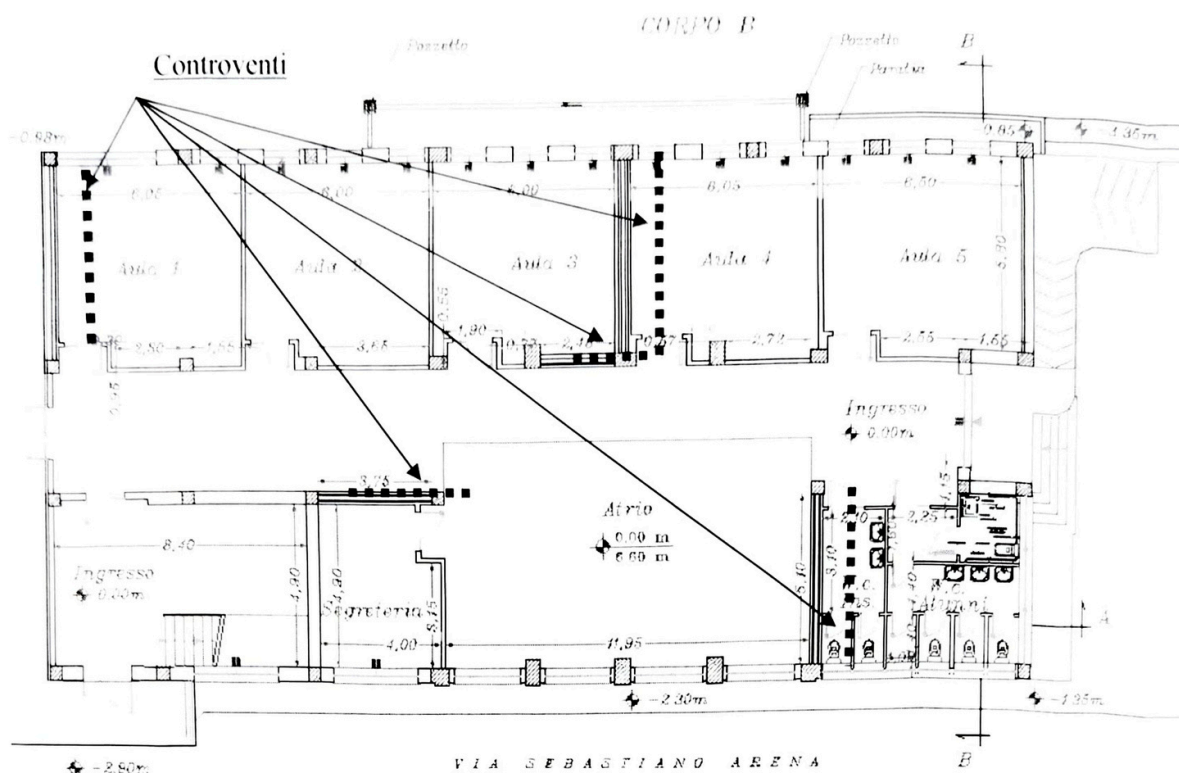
Pianta piano terra con indicazione della posizione dei controventi.
